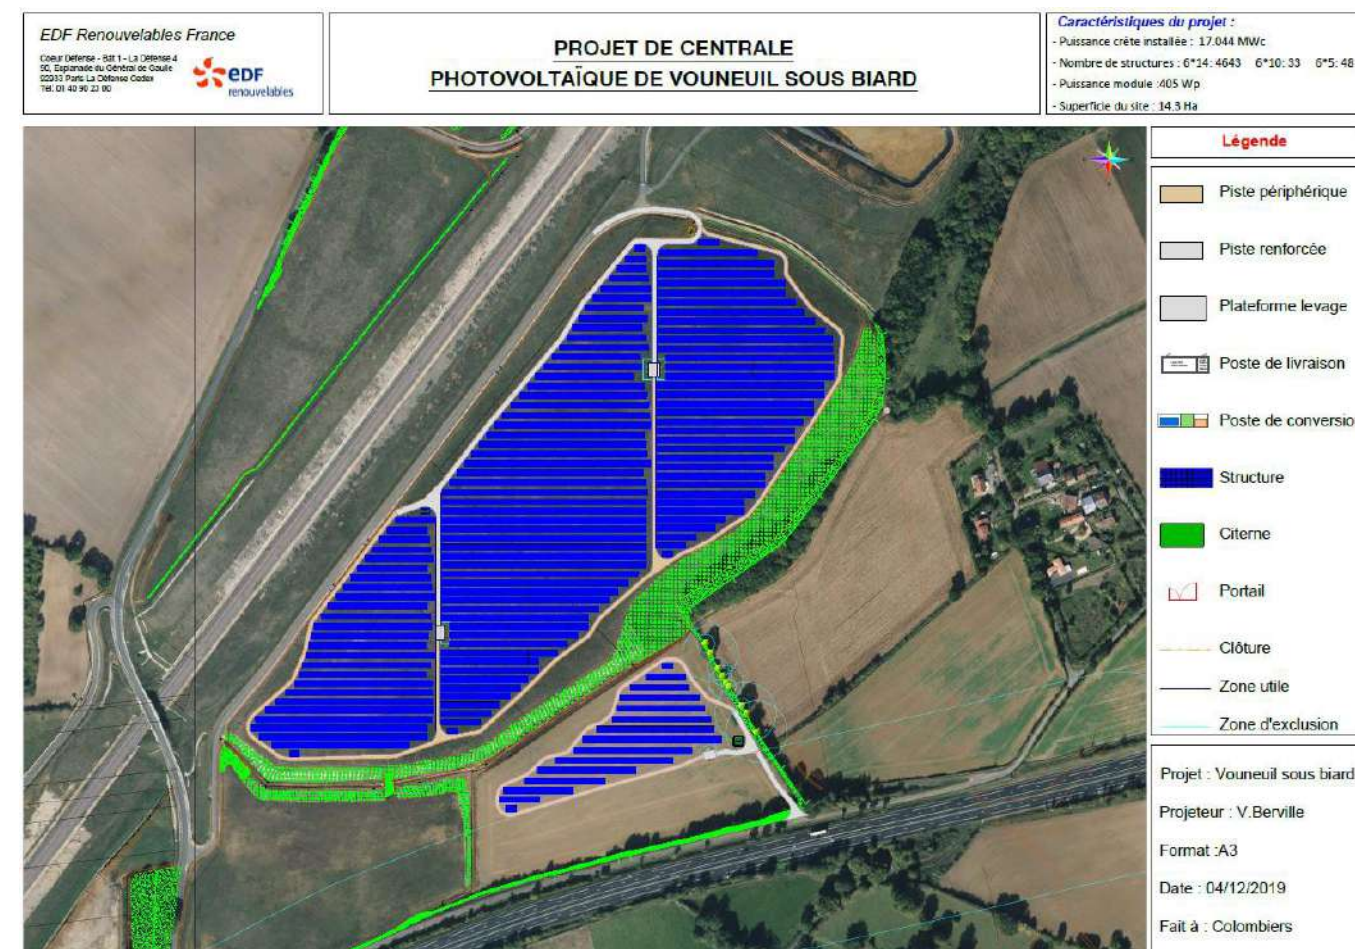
Variante d'implantation n°2 (Source : EDF Renewables)
